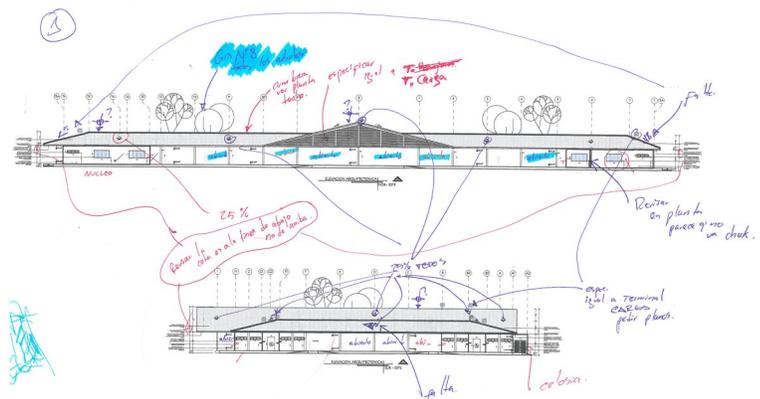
Plano: Elevaciones Proyecto Tiangué.
